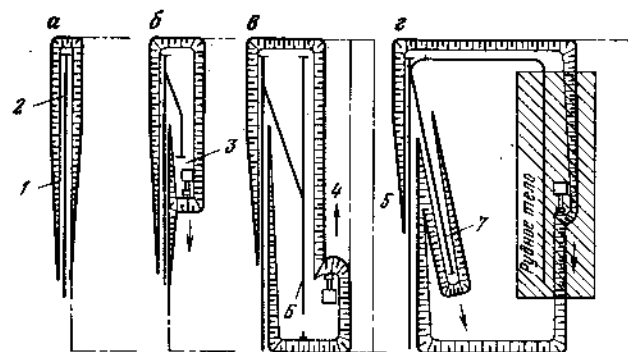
Схема транспортной системы разработки с вскрытием тупиковыми съездами и перевозкой породы на внешние отвалы:
